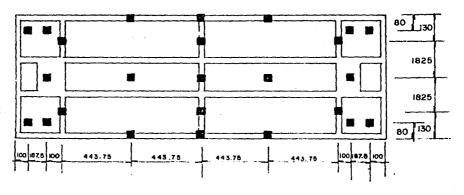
PLANTA Y ELEVACION DE APOYOS 4 Y 5, LOCALIZACION Y UBICACION DE PILOTES.
